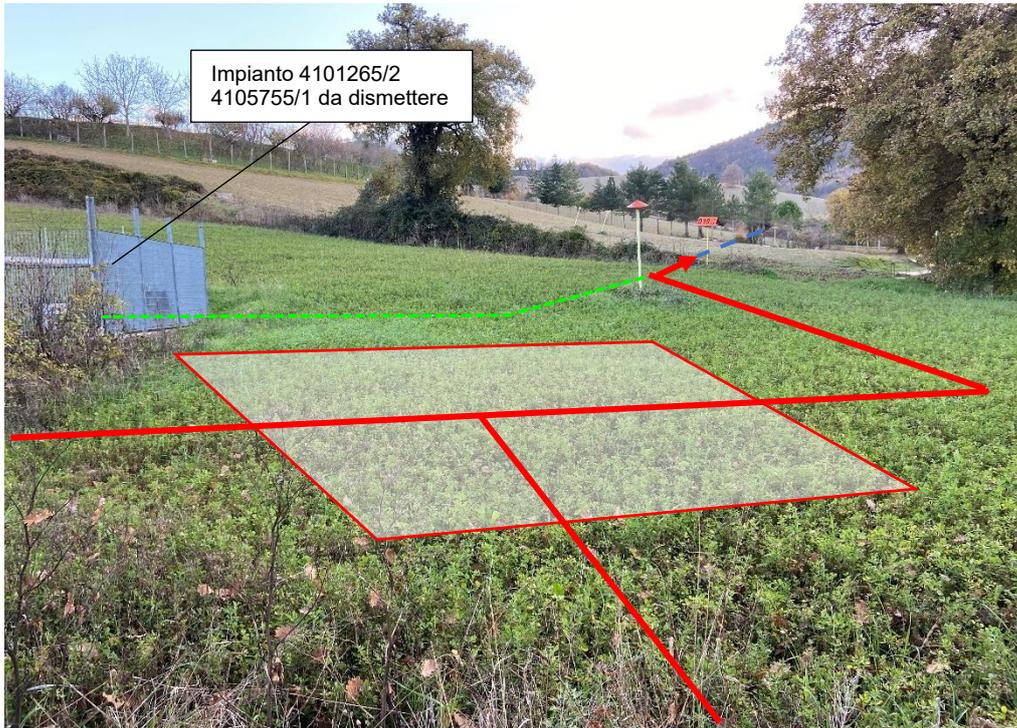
Variante su Collegamento Potenziamento Fabriano con Derivazione Gualdo Tadino e realizzazione Impianto PIDI
